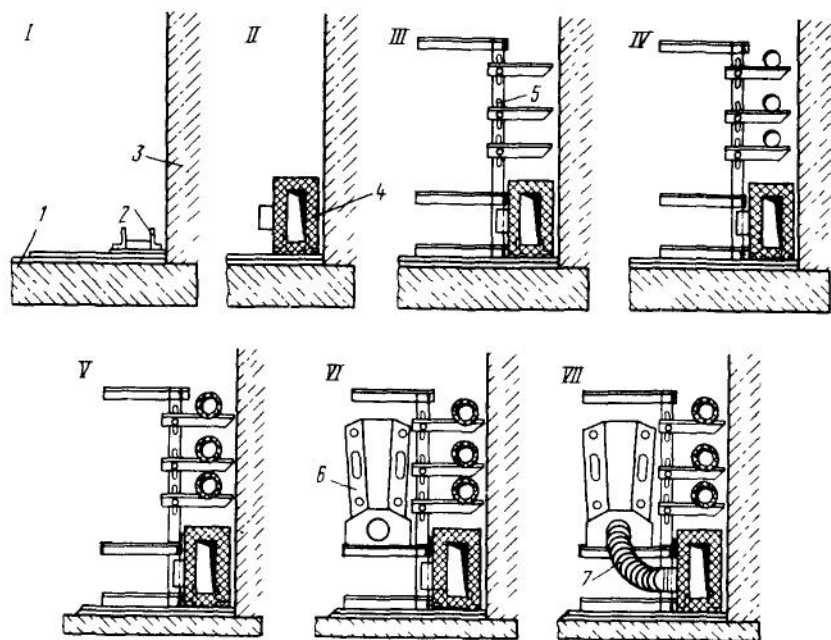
Последовательность монтажа (положения I...VII) эжекционных доводчиков: 1 – верх железобетонной плиты, 2 – опора, 3 – стенная панель, 4 – воздуховод, 5 – каркас под доводчик, 6 – доводчик, 7 – патрубок (воздуховод)
